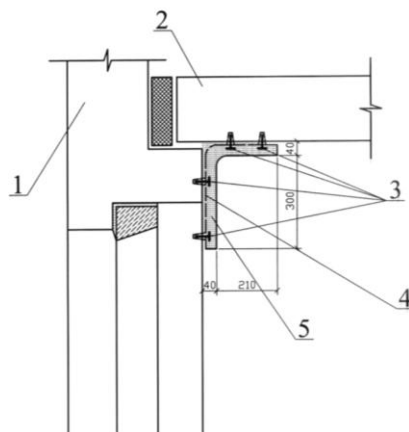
Утепление карнизного узла: 1 – наружная стеновая панель; 2 – плита перекрытия; 3 – дюбели в деревянных пробках; 4 – штукатурная сетка; 5 – теплая штукатурка
